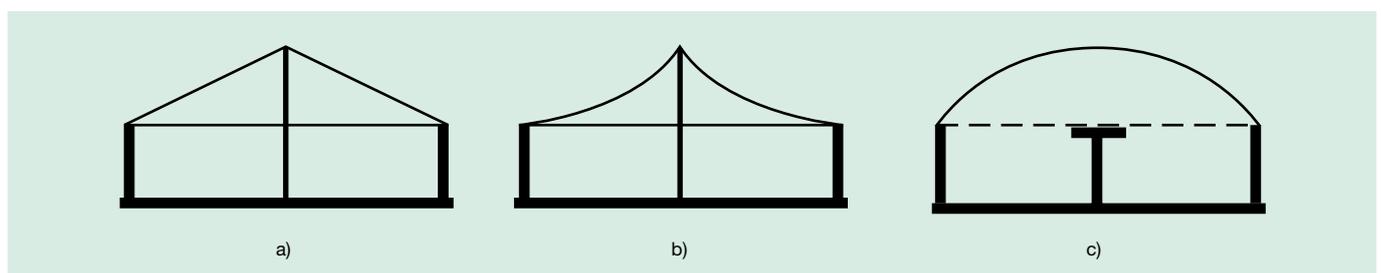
Fermenterabschluss mit Hüllkonstruktion, a) Kegelfläche, b) Sattelfläche, c) Kugelfläche
